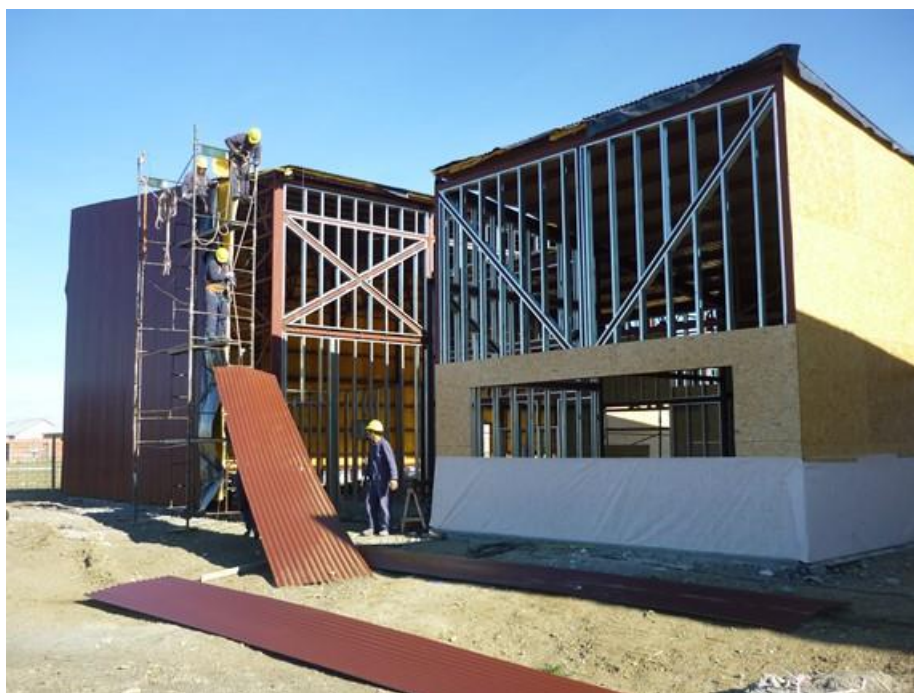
Centro Cultural y Auditorio – Comte Luis Piedrabuena
